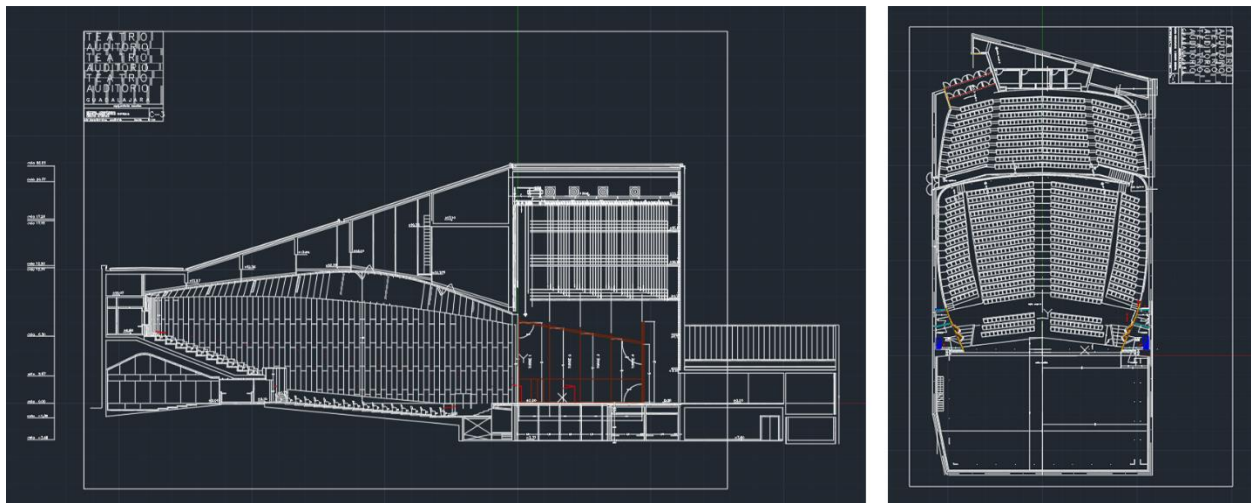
Planos del auditorio importados en AutoCAD: vistas en sección (izq.) y planta (dcha.)
